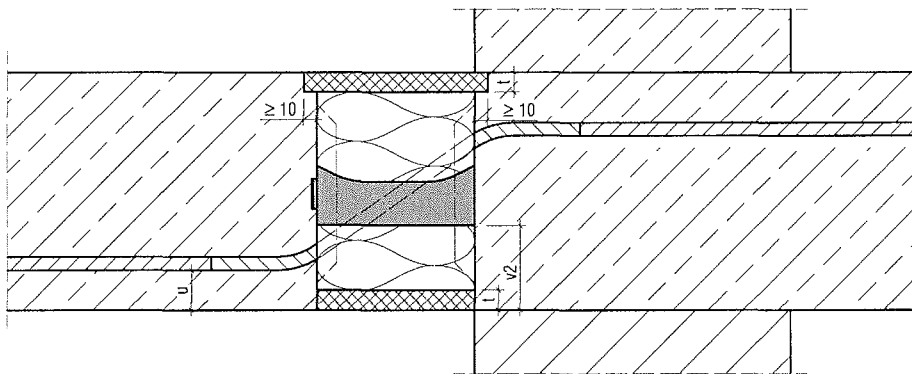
Schöck Isokorb Typ Q (F30/F90)
